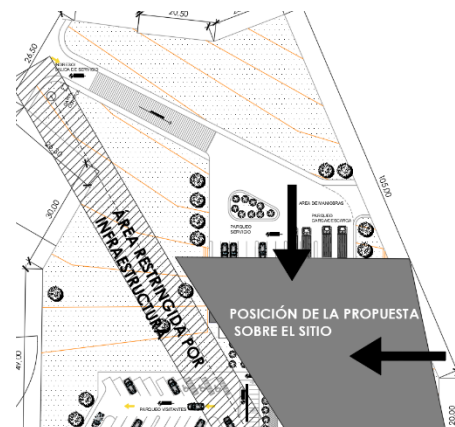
plano de distribución de conjunto, propuesta para mercado cantonal de Chukmuk
